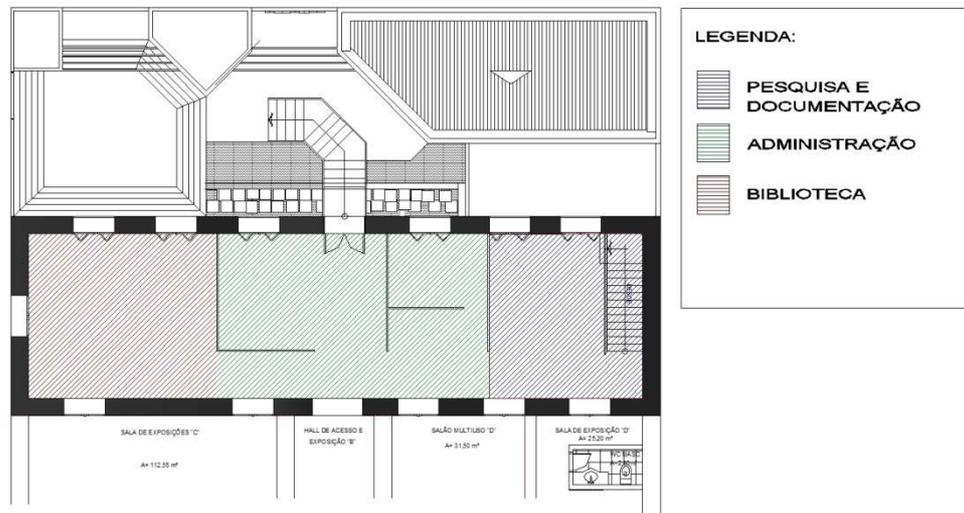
Recorte do Pavimento Térreo do Museu (2010).
